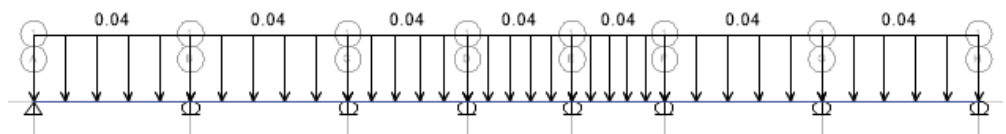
Carga de tabiquería y piso terminado en vigueta de losa aligerada
